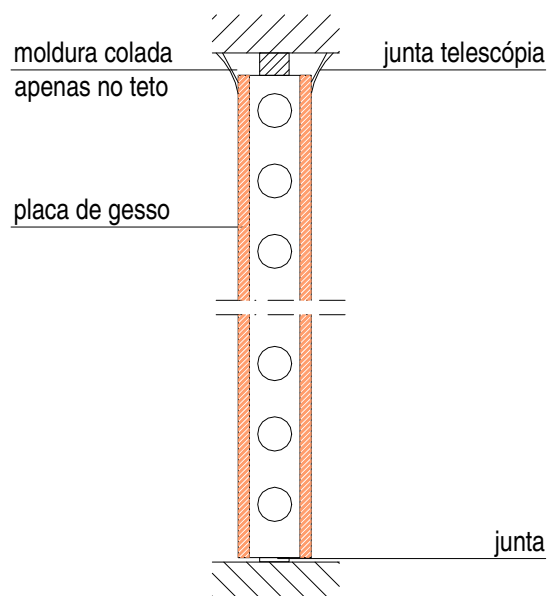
Junta telescópica entre o gesso acartonado e a laje superior
